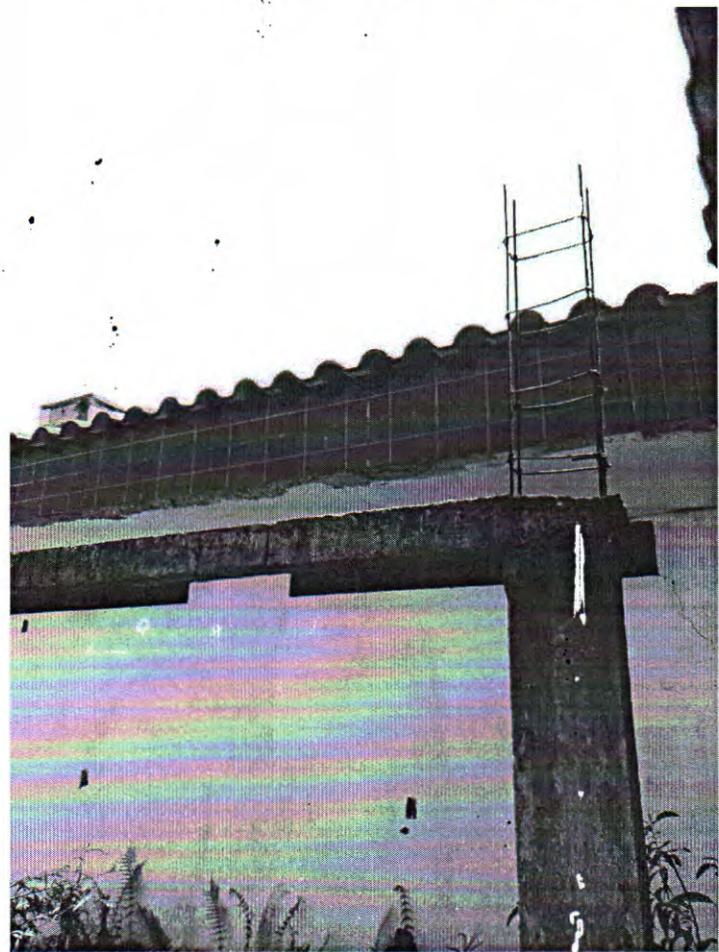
Vigas do varal executadas com seção fora da norma. Fonte: Acervo Técnico.
